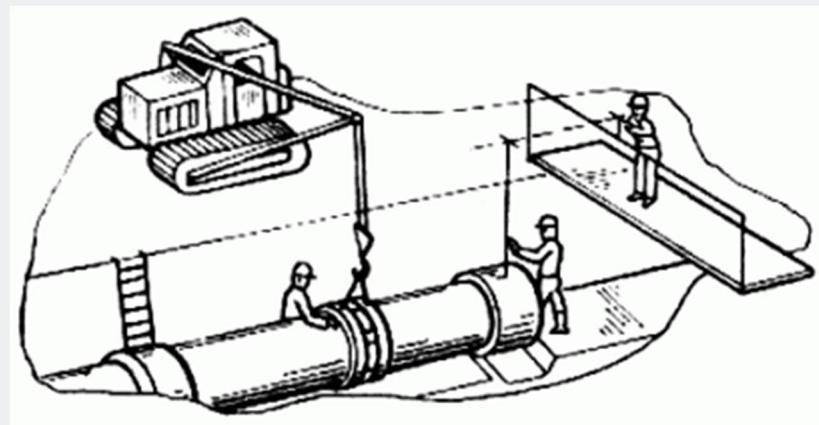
Выверка положения трубы по вертикали с помощью визирок
